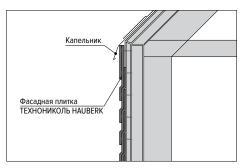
Монтаж верхнего ряда в домах без карнизного свеса
